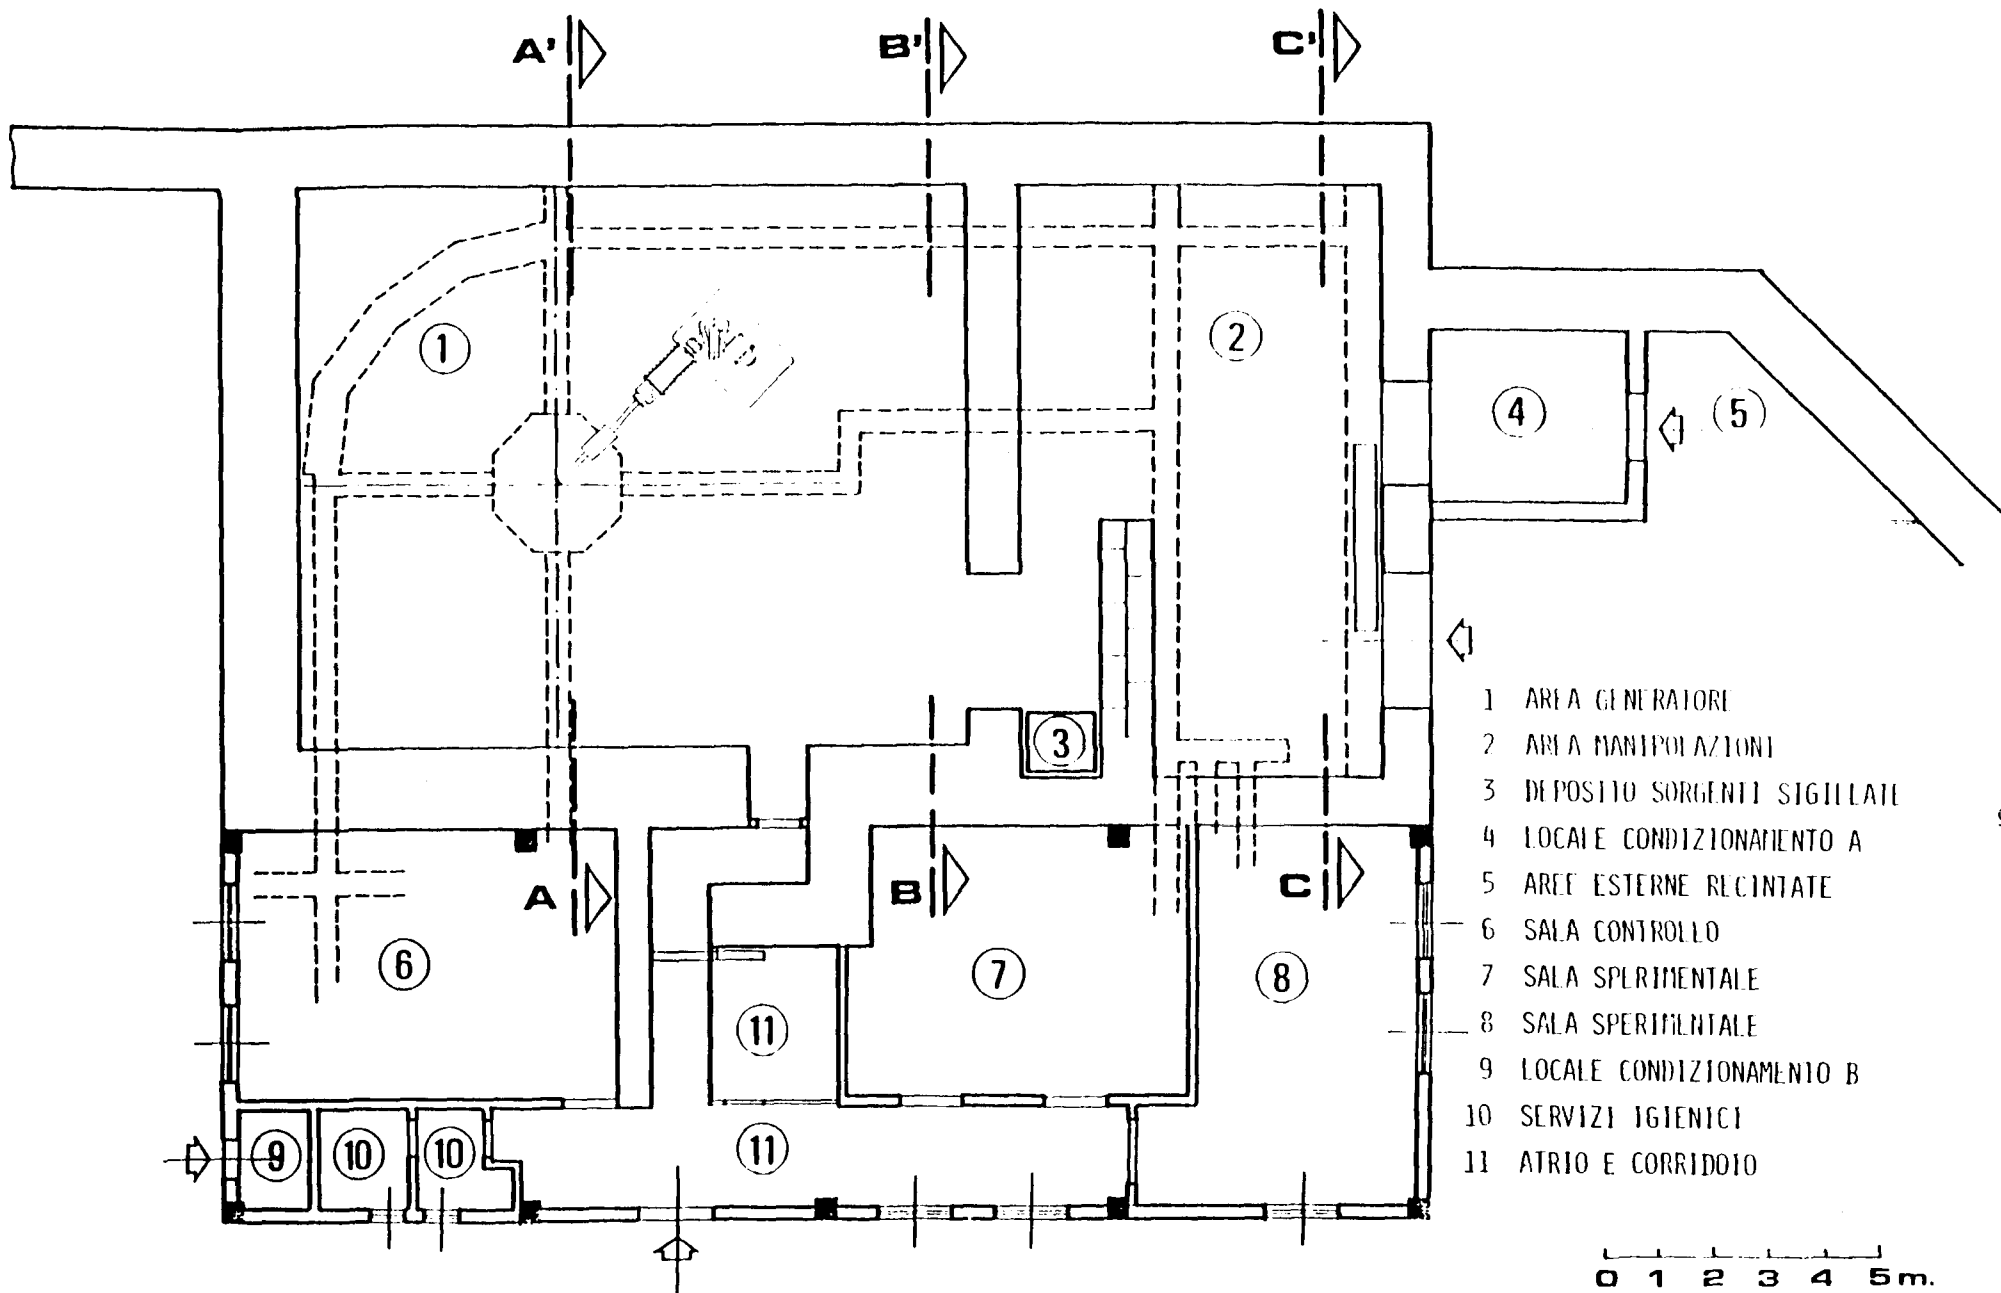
Planimetria della sala del generatore e dei locali attigui con
